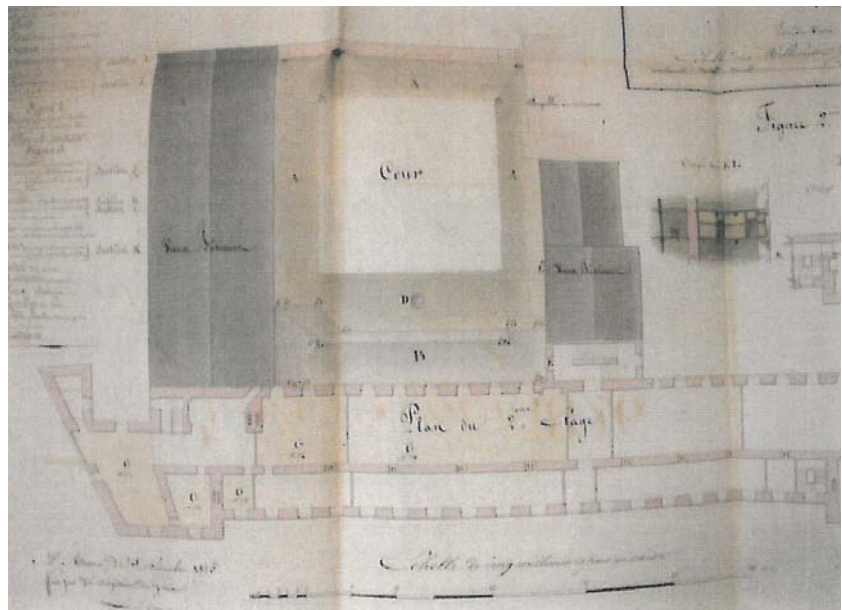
Le plan de 1825 révèle la présence de nouvelles constructions installées dans la cour © S.H.A.T. 1VH 1531
